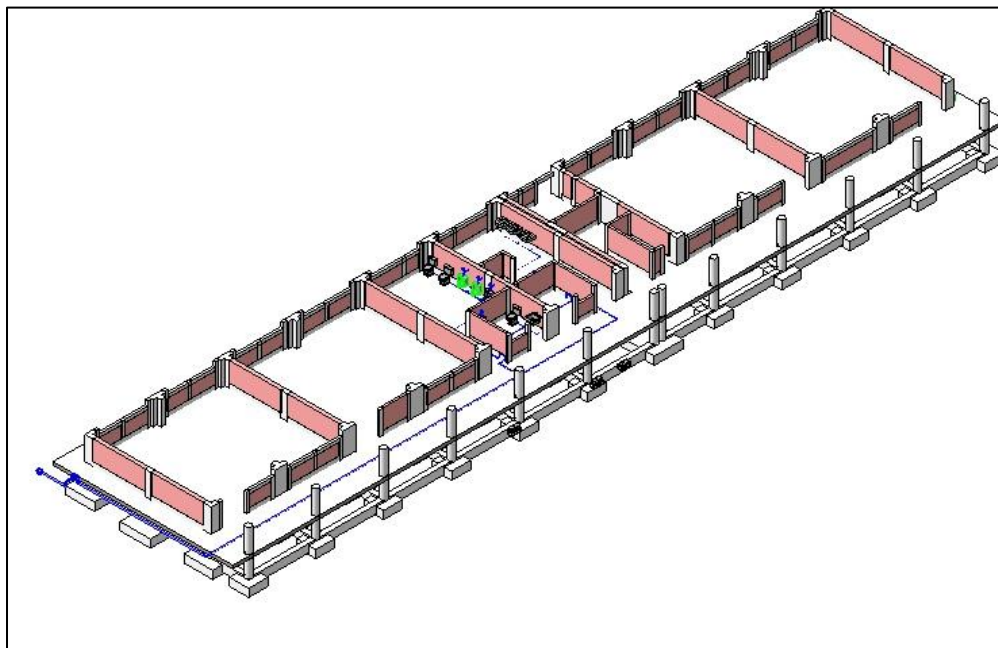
Modelado estructural I.E. N° 56435 vista con detalle nivel 2
